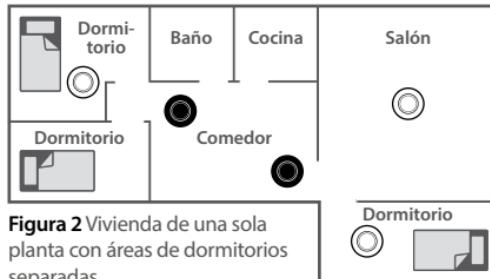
Vivienda de una sola planta con áreas de dormitorios separadas
